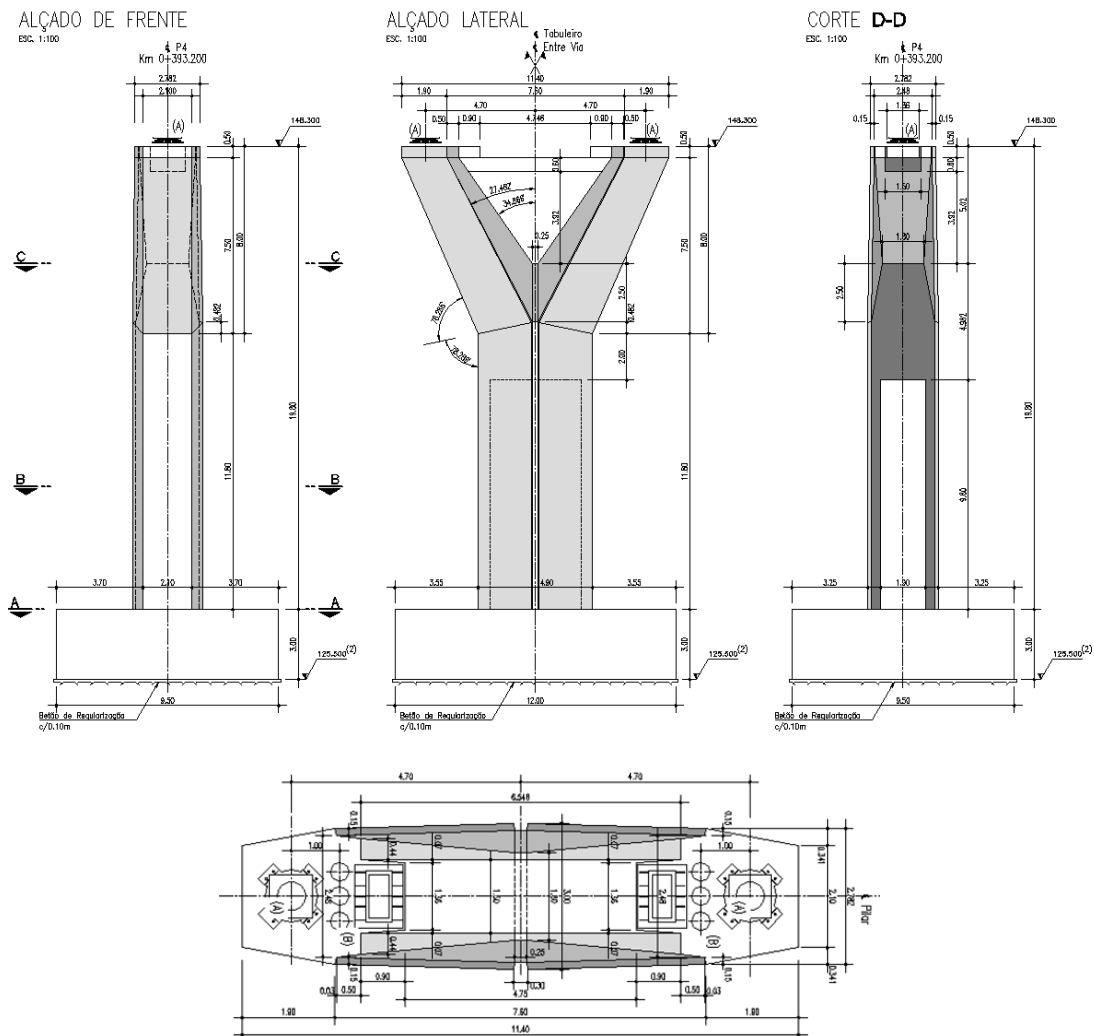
Alçados do Pilar P4 e planta ao nível dos aparelhos de apoio
